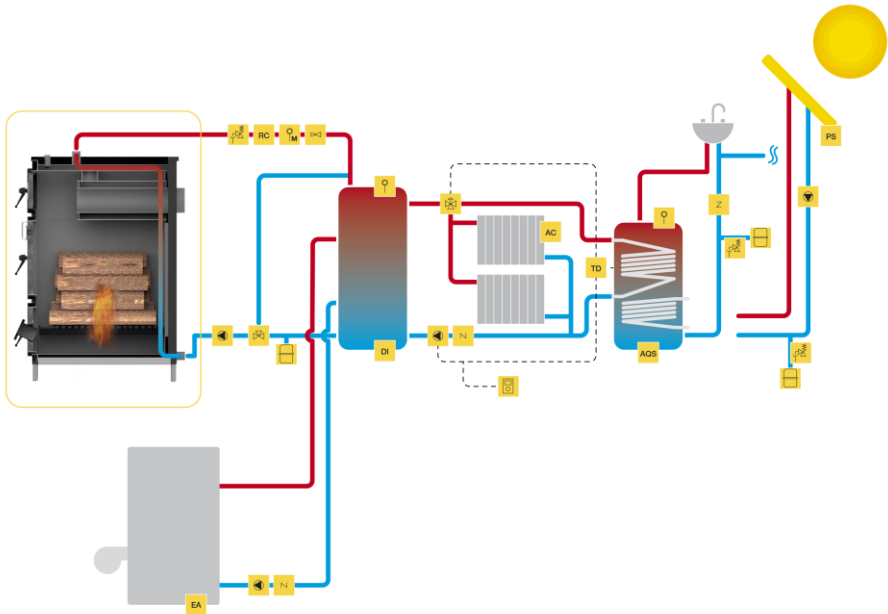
Esquema de instalação para aquecimento central, AQS e painel solar com apoio de caldeira a pellets.
